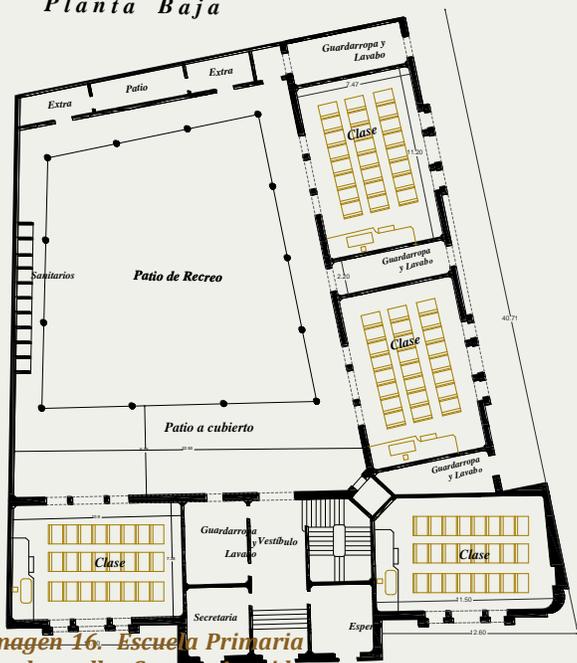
Escuela Primaria en la calle Sur y Avenida Poniente 14.
